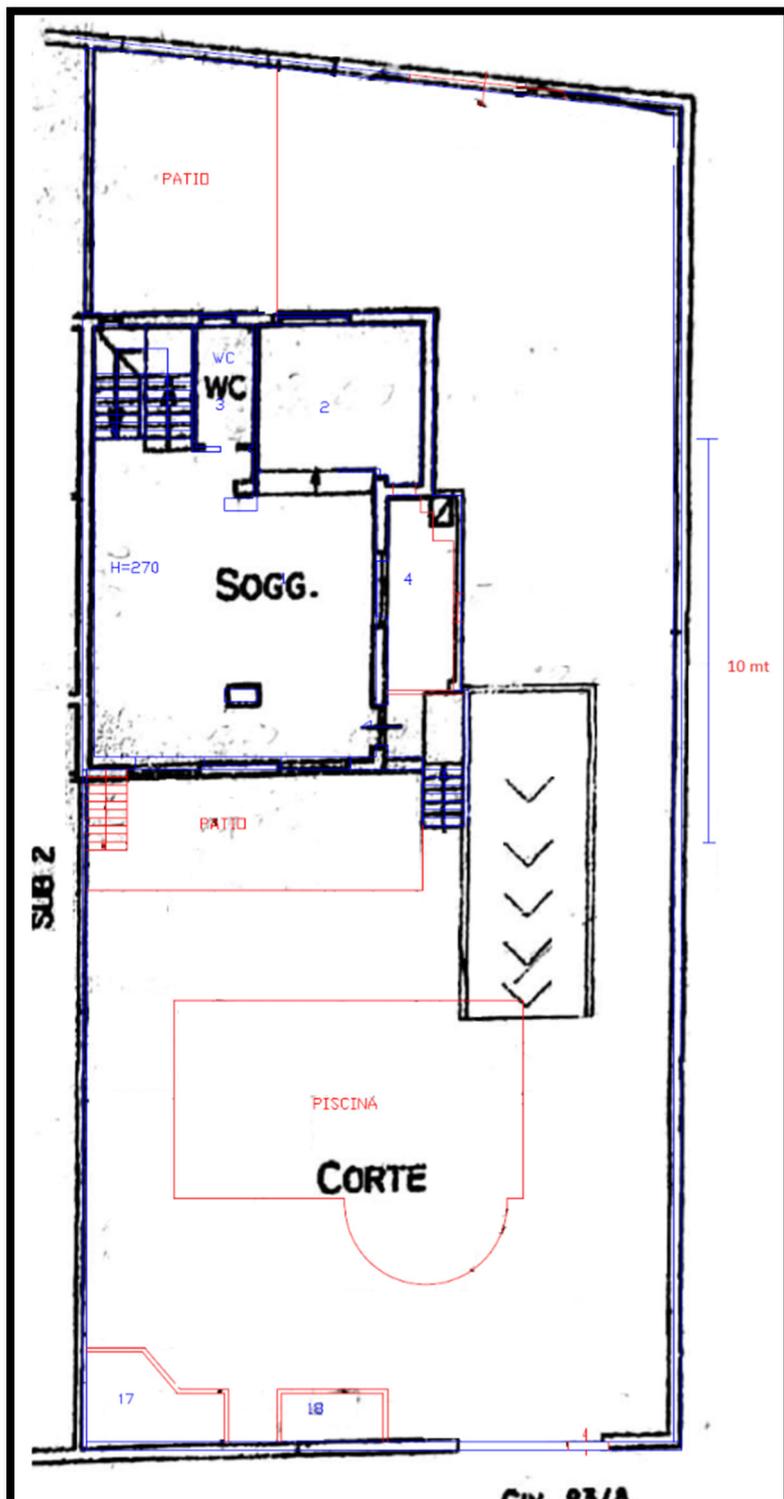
Sovrapposizione stato attuale-planimetria catastale piano terra
